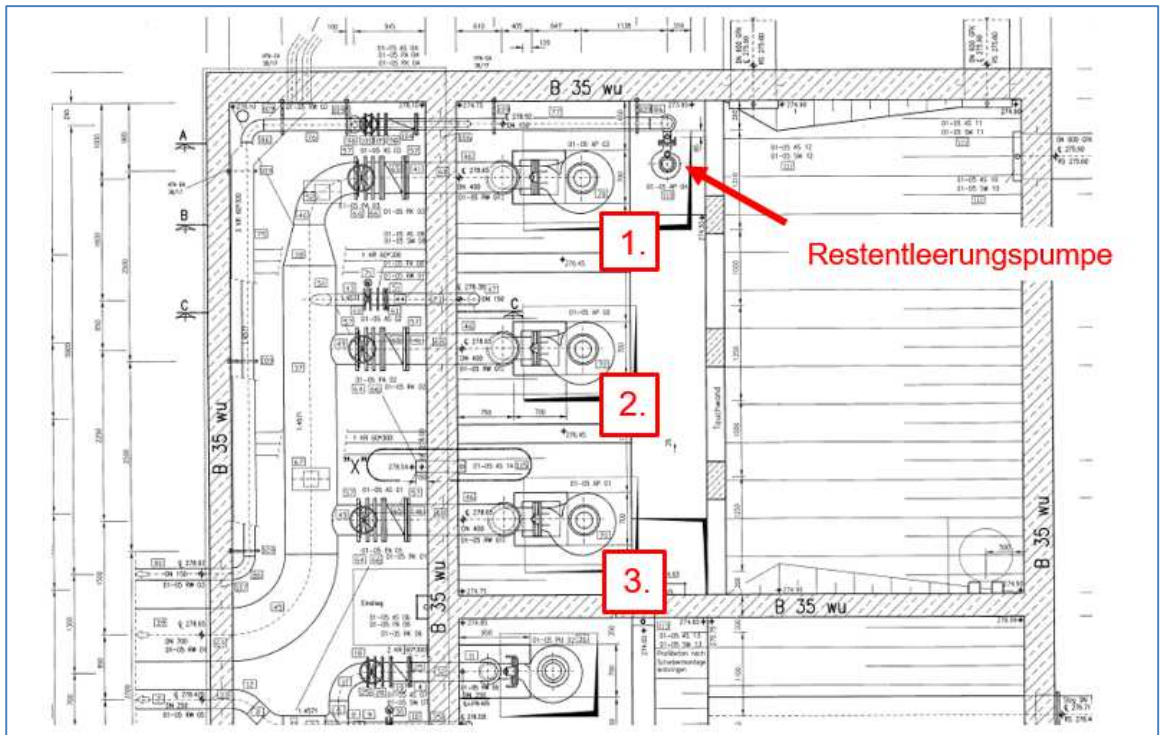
Grundriss, Bauwerk „Rückpumpanlage“
